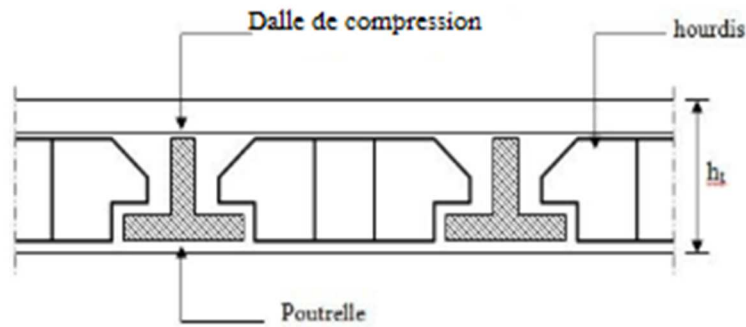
Coupe transversale d'un plancher à corps creux.
